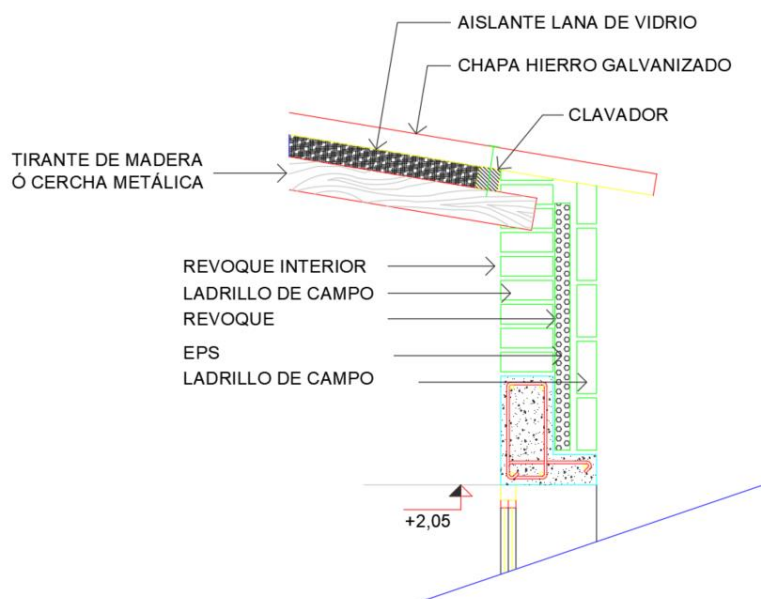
Detalle constructivo de muro y cubierta de la vivienda
